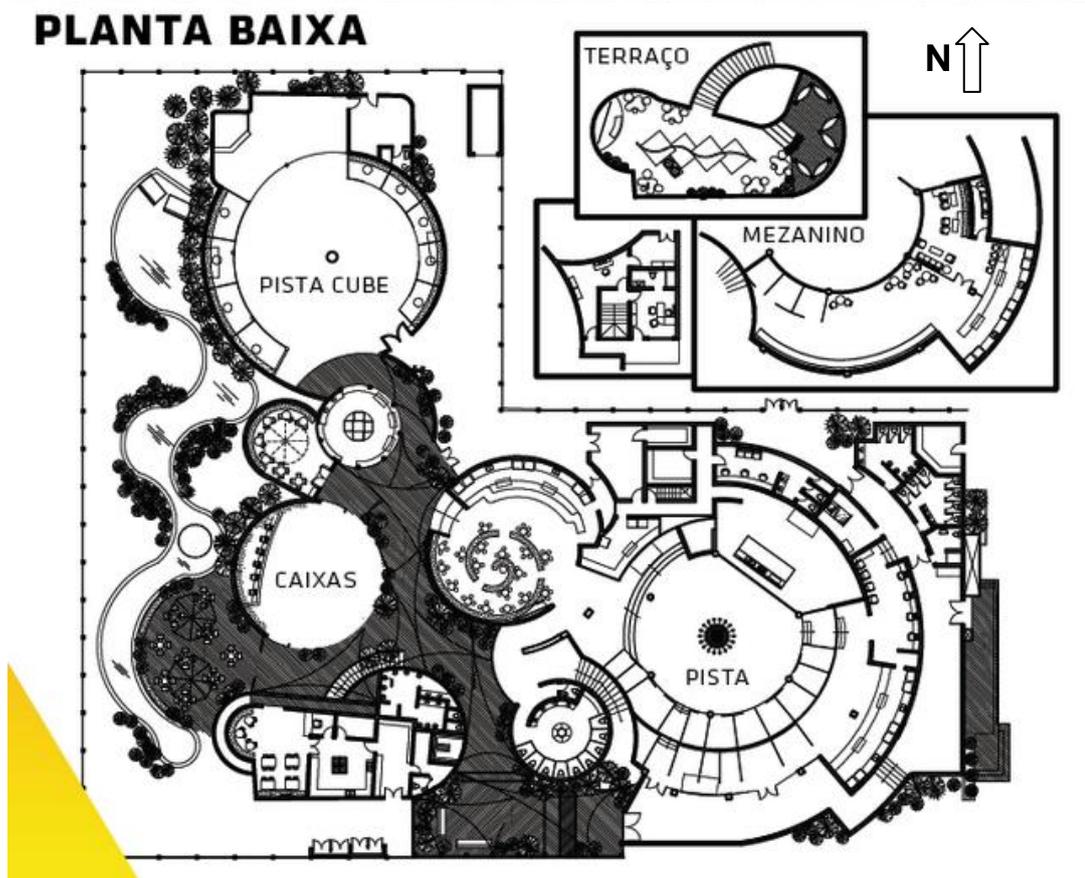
Planta Baixa Primeiro Pavimento e Segundo Pavimento
